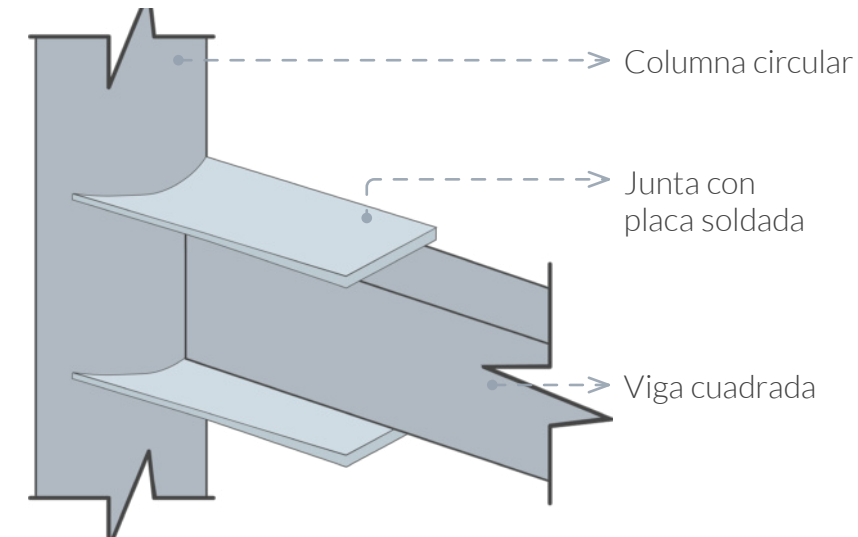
Detalle de junta de viga y columna. Elaboración propia.
